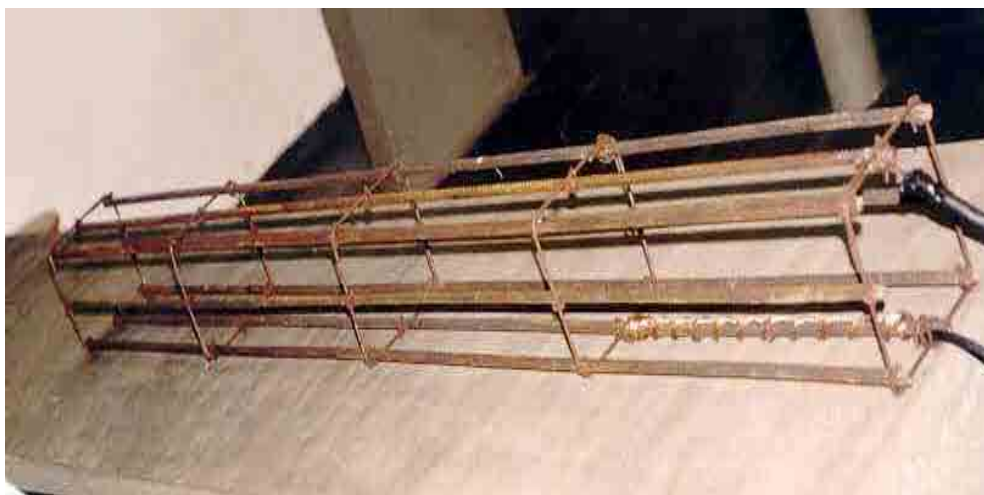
Armadura de aço para confecção do bloco de concreto
